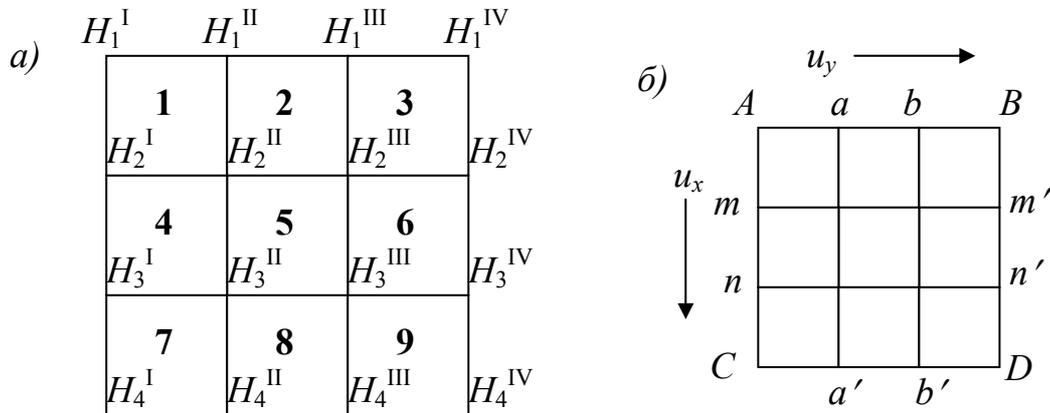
Сетка квадратов: а – для проектирования горизонтальной площадки; б – для проектирования наклонной площадки.
